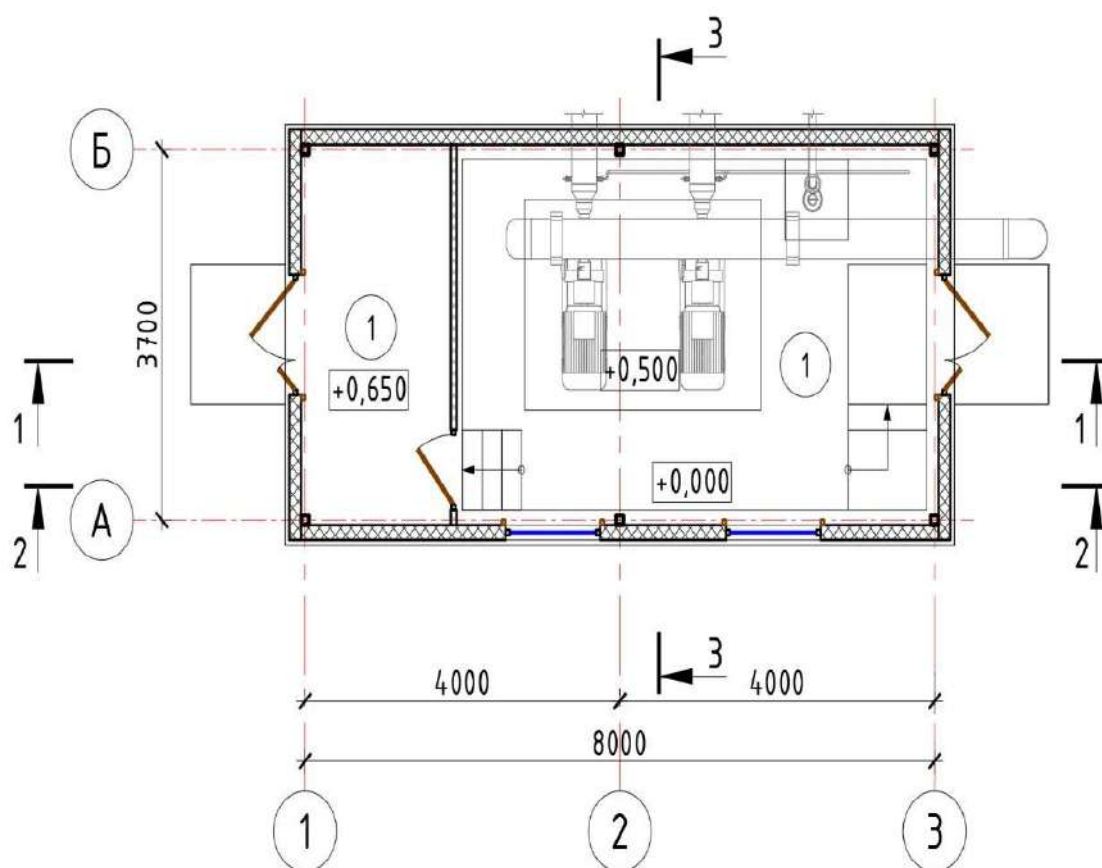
План здания насосной станции пруд накопителя оборотной
